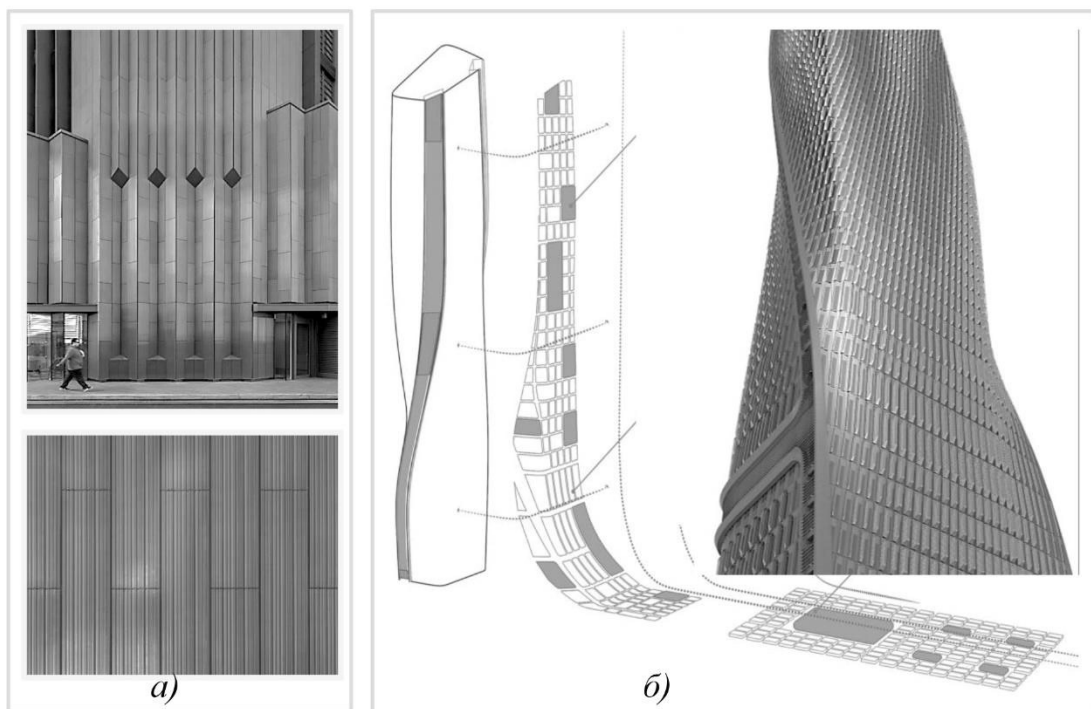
Приклад структурного утворення кольору фасаду. *а* - Metropolitan Workshop's будівля з фасадом із бірюзової глазурованої теракоти [16]; *б* - Wasl Tower, Дубаї, ОАЕ з фасадом облицьованим глазурованою керамічною плиткою [17].
